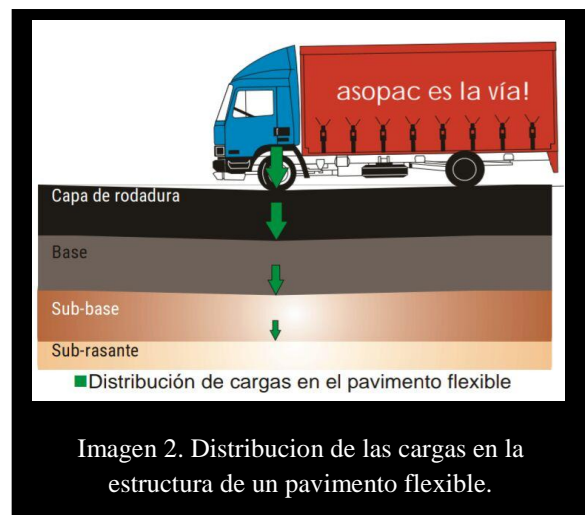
Distribución de las cargas en la estructura de un pavimento flexible.
